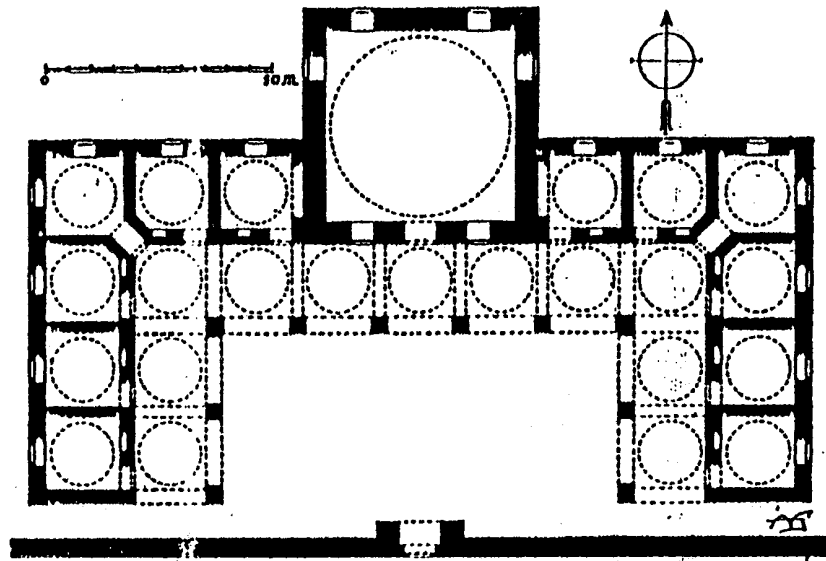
مسقط أفقي للمدرسة ضمن المجموعة الخضراء في بورصة أو بروسه
